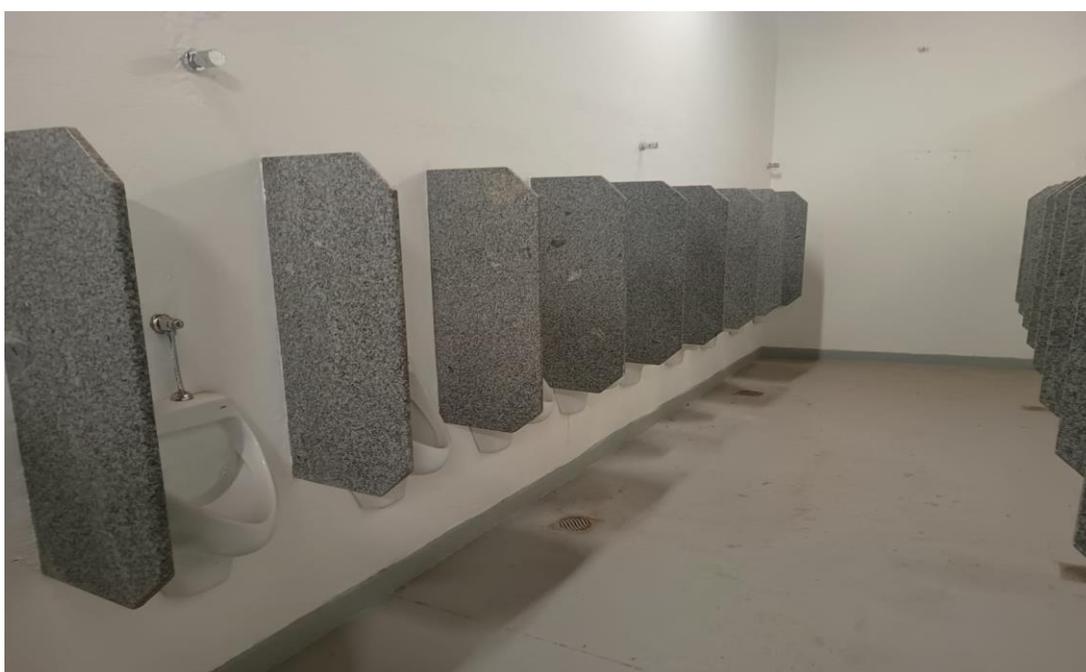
Centro de Operações e Vigilância em condições satisfatórias
